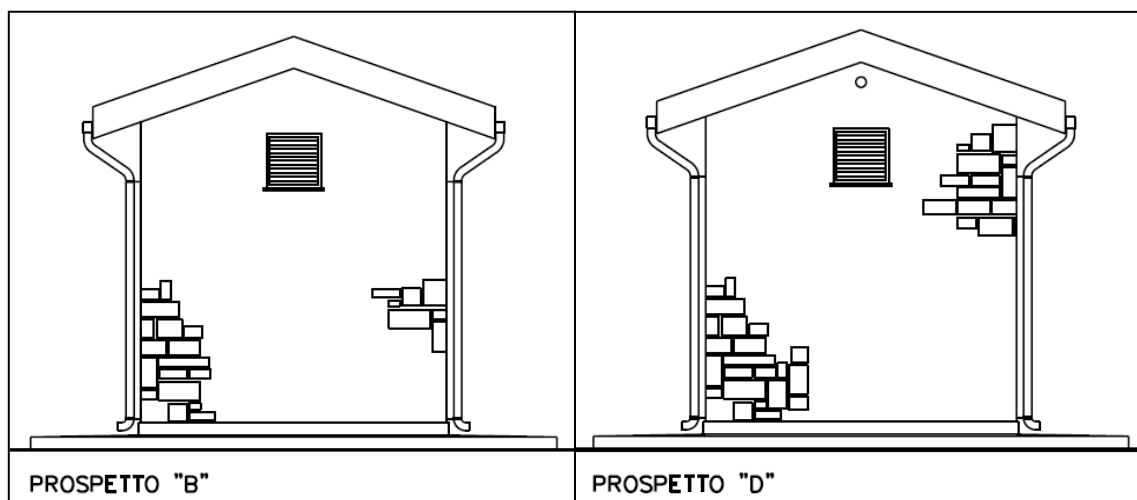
Edificio Tipo B5 – Prospetto “B” e Prospetto “D” (*riproduzione non in scala*)
